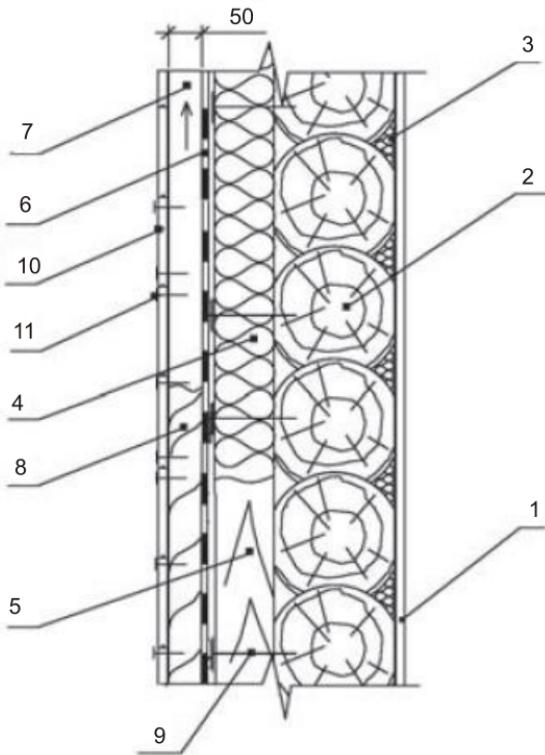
Утепление стены из бревен плитами ИЗОРОК в один слой по деревянному каркасу с облицовкой листовым или плитным материалом в конструкции с вентилируемым зазором: 1 — внутренняя отделка; 2 — стена из бревен; 3 — уплотнитель — плиты ИЗОЛАЙТ¹; 4 — плиты ИЗОВЕНТ; 5 — деревянный каркас из брусков; 6 — супердиффузионная мембрана ISOROC FOIL HI; 7 — вентилируемый зазор; 8 — вертикальная деревянная планка; 9 — дюбель или гвоздь с шайбой; 10 — внешняя отделка; 11 — крепежный элемент (винт, шуруп)
